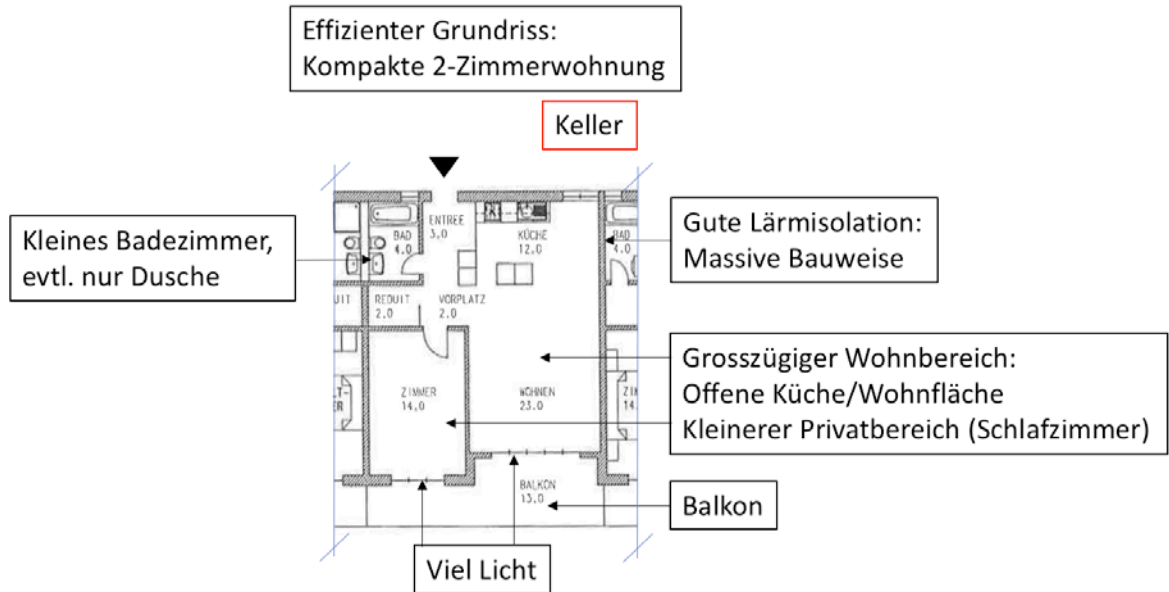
Zweizimmerwohnung. Beispiel für einen Grundriss (vgl. Hoskin, J., Reimer, T. 2011, S. 41)
